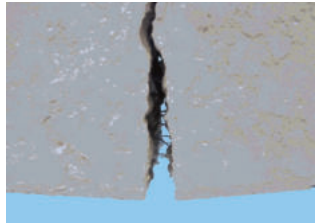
Rissbild Stahlfaserbeton
